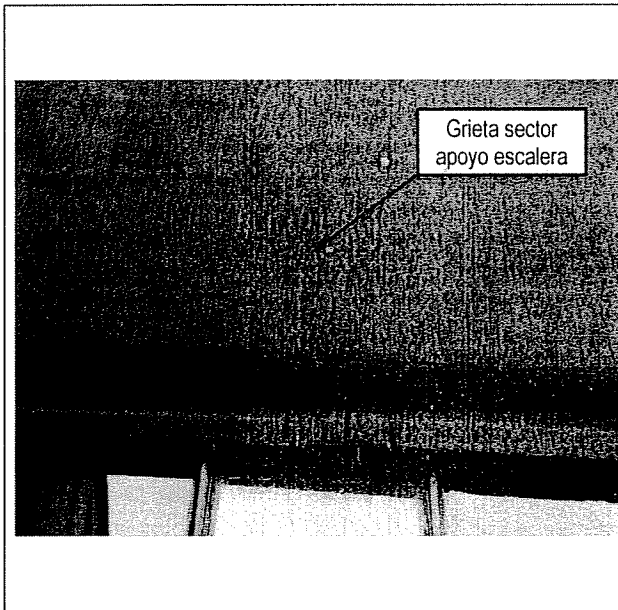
Grieta que revela la condición de apoyo simple de las escaleras (izquierda) y que se prolonga verticalmente en el muro.
